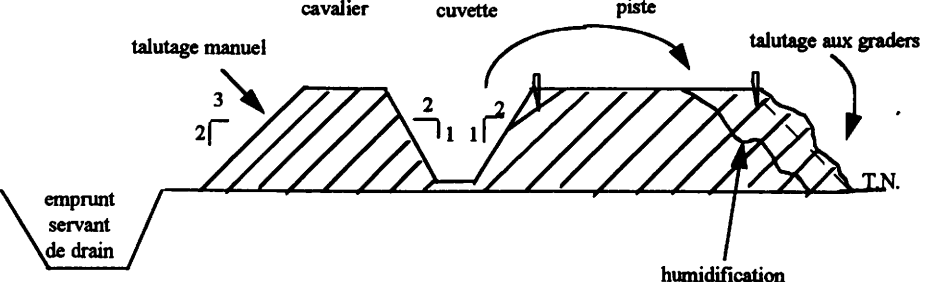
Profil en travers type de l'arroseur monolatéral type 2 (piste sur drain).
